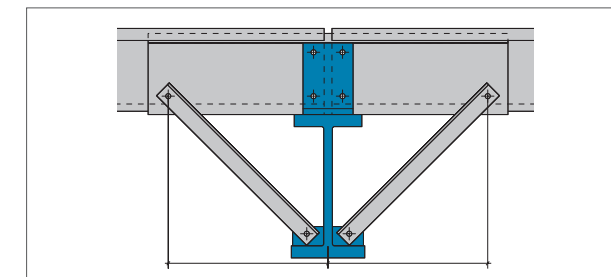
Příklad umístění a napojení lemovacího úhelníku
